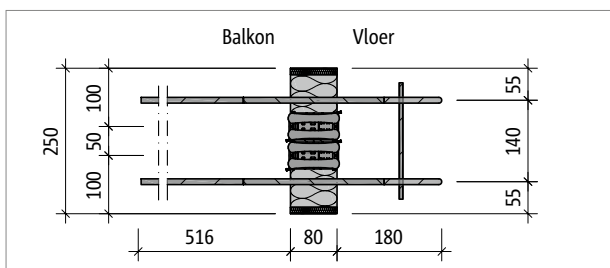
Schöck Isokorb® T type Q-E-V5-L500: Bovenaanzicht
